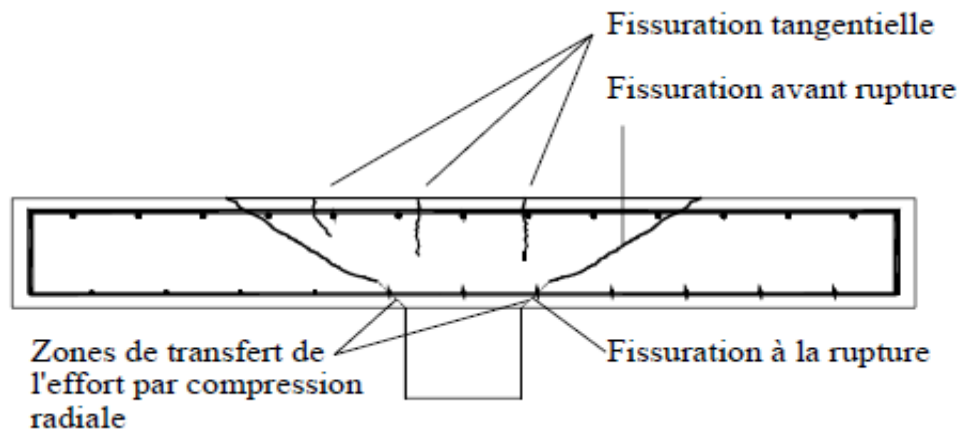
Fissuration lors d'une rupture par poinçonnement [87]
